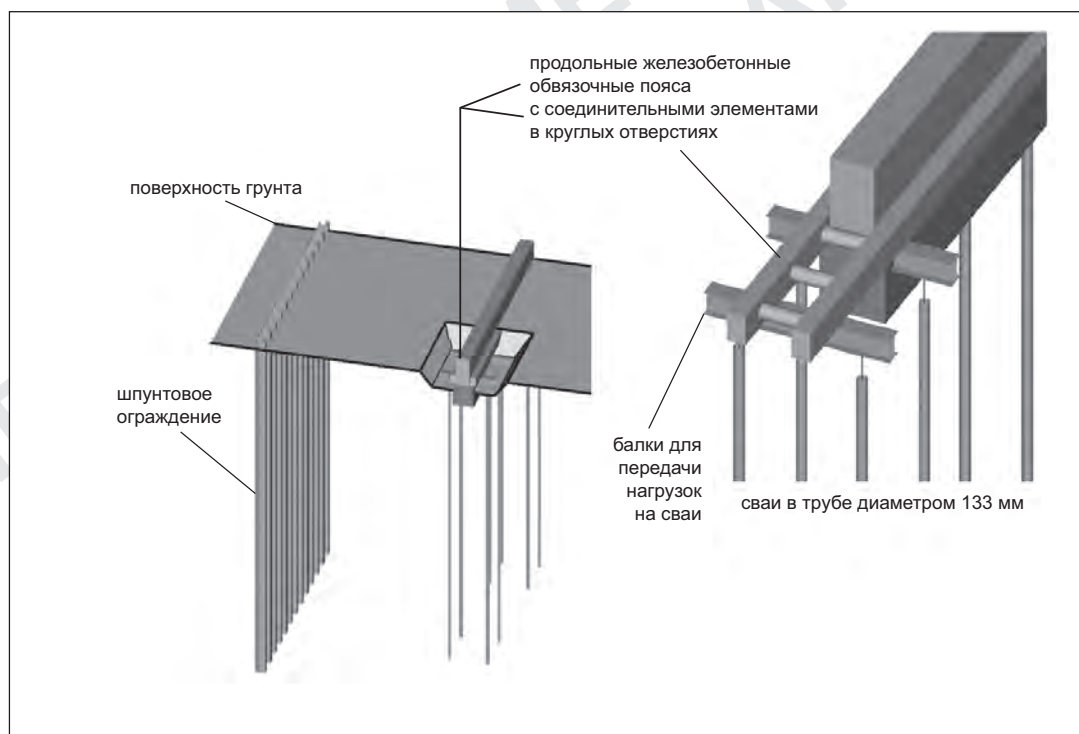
Устройство шпунтового ограждения, буроинъекционных свай и узла передачи нагрузки от стен на сваи
